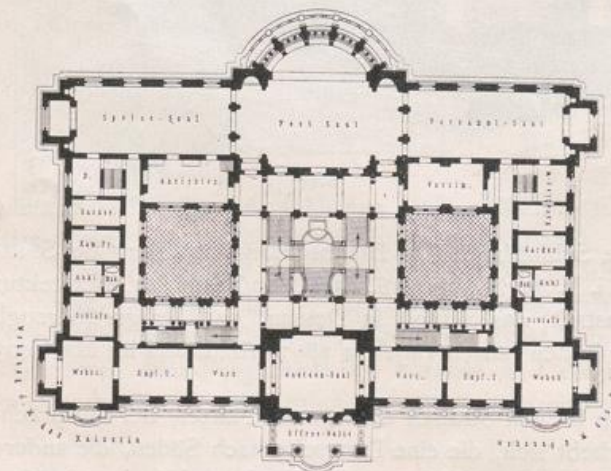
Grundriß des Kaiserpalastes in Straßburg. Arch.: H. EGGERT.
